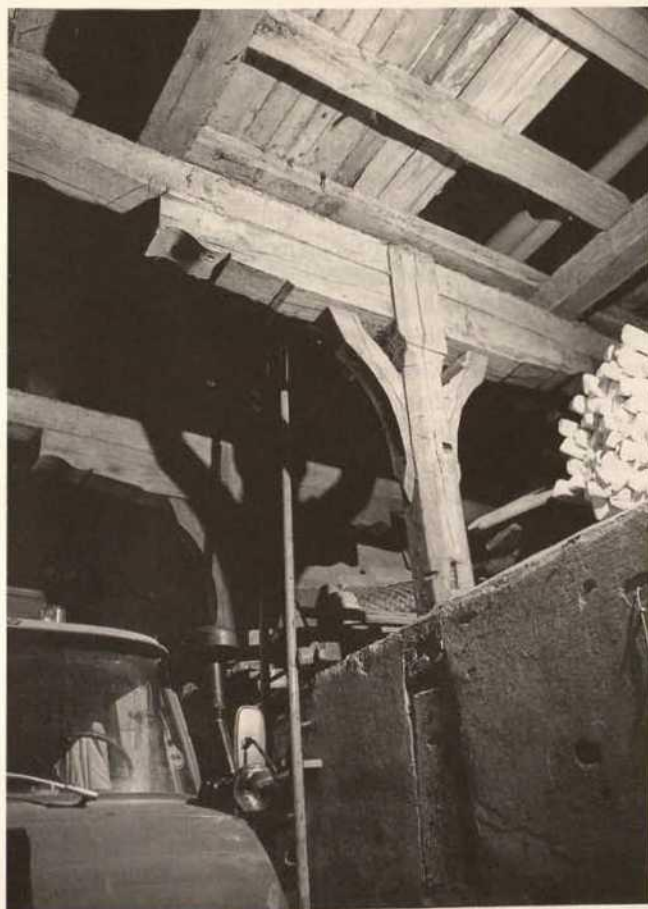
Münsterstadt, Finstere Gasse, Detail Fachwerk.
